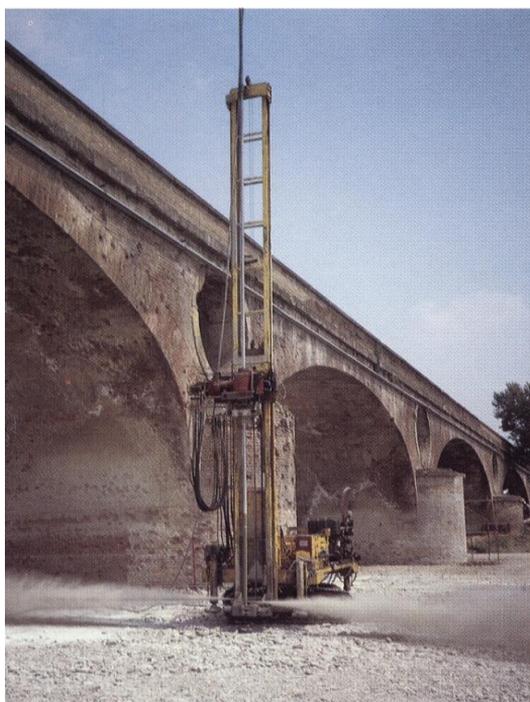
Работа установки («jet grouting») струйной цементации
